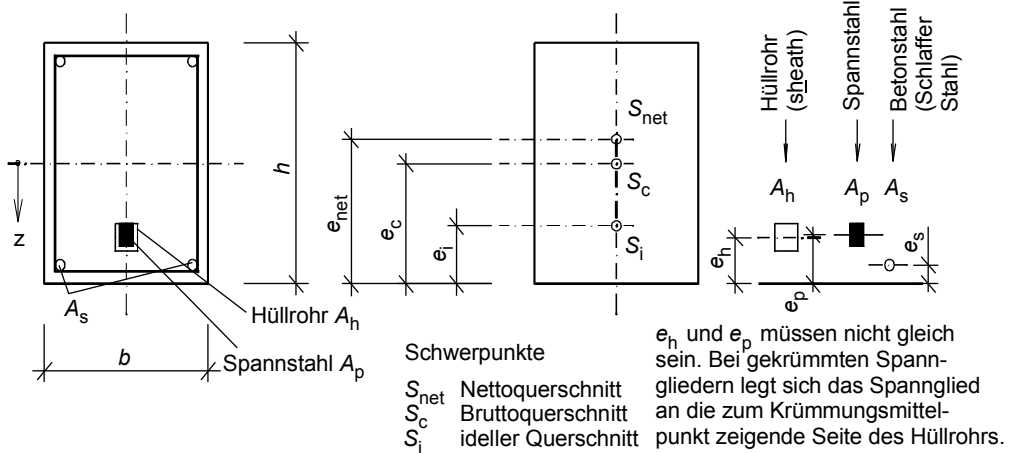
Querschnittsbezeichnungen im Spannbetonbau
